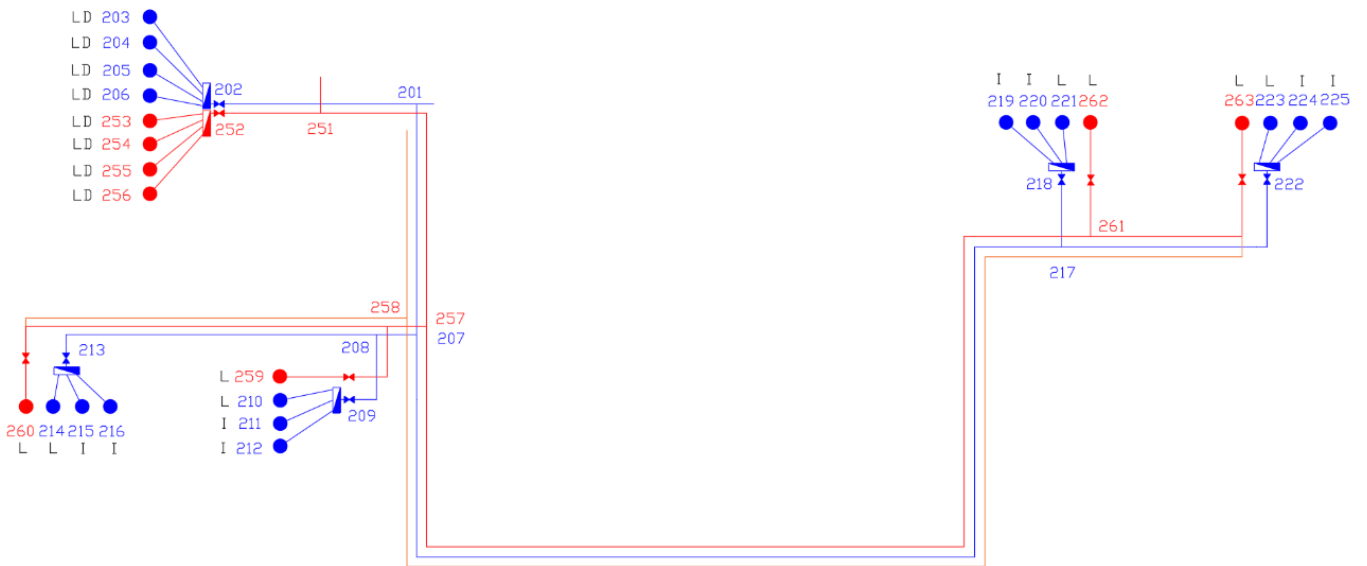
Esquema de líneas, nudos y suministros planta baja.
